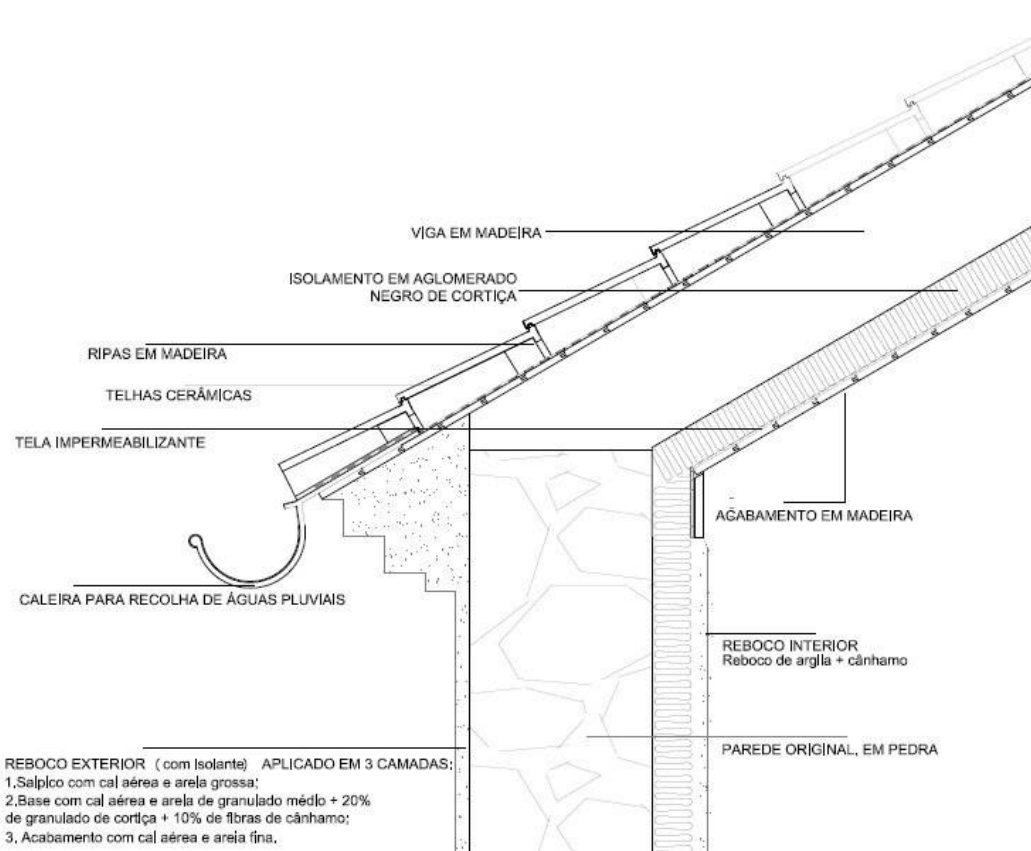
Pormenor de parede exterior e cobertura, edifício 1
